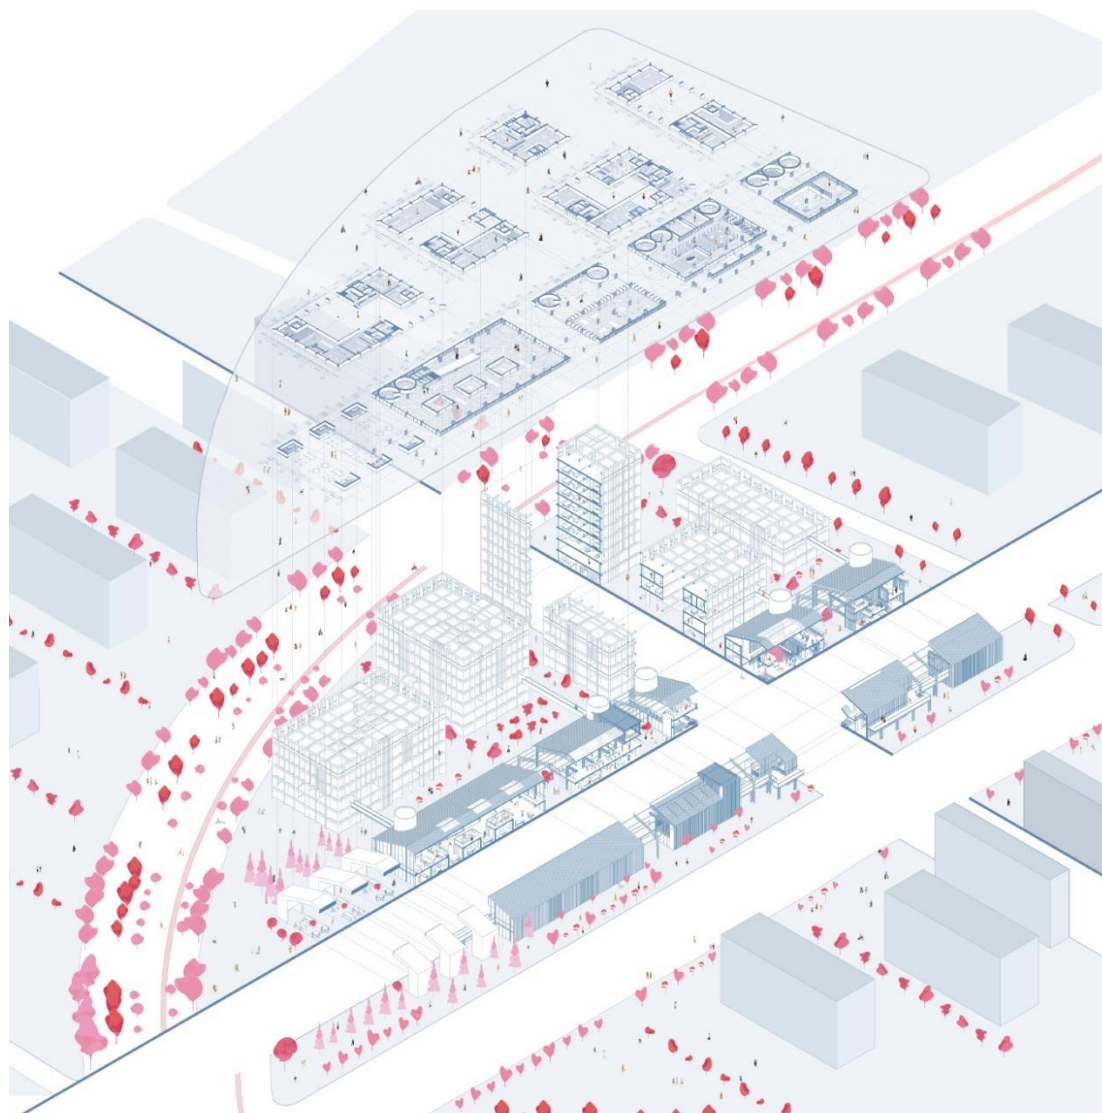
Implantación de proyecto arquitectónico. Elaboración propia.
